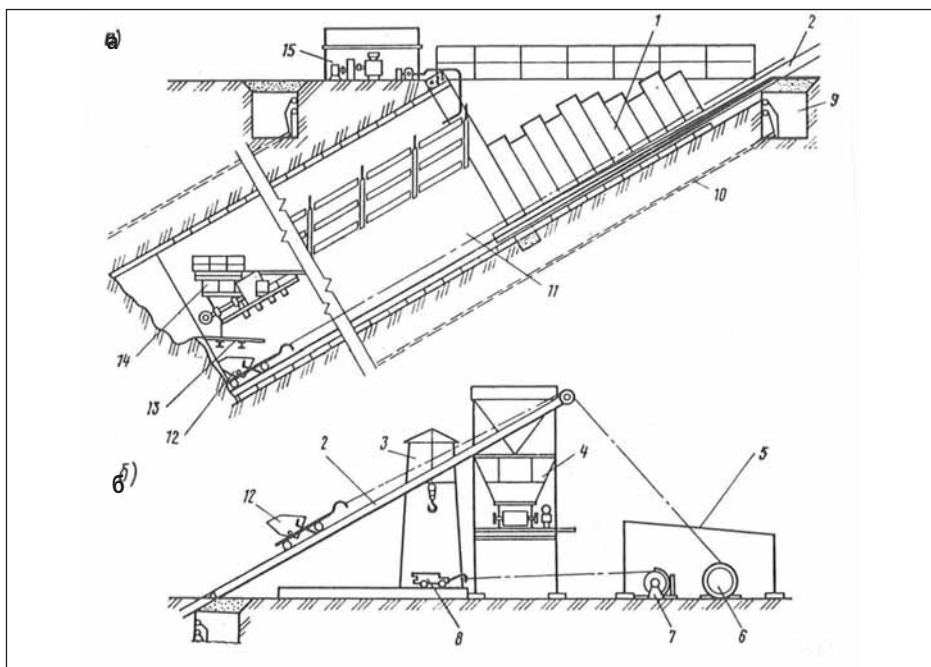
Схема организации работ по проходке наклонного тоннеля: а – зона подземных работ; б – верхний комплекс; 1 – временный оголовок; 2 – наклонная эстакада; 3 – тельферная эстакада; 4 – бункерная секция; 5 – машинное помещение; 6 – лебедка скипового подъема; 7 – лебедка для спуска тубингов; 8 – тубинговозка; 9 – галерея; 10 – замораживающая колонка; 11 – наклонный тоннель; 12 – скип; 13 – погрузочная платформа; 14 – тубингоукладчик; 15 – компрессорная
